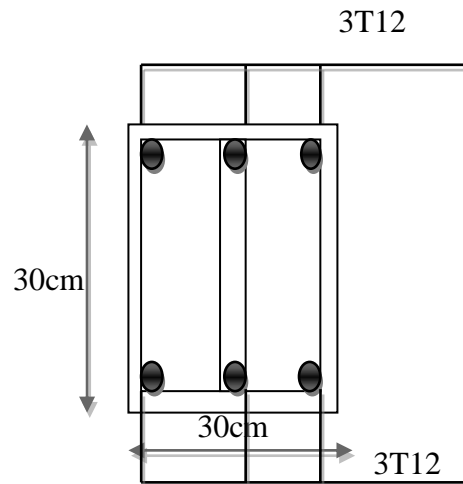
Ferrailage de la poutre secondaire en appuis
